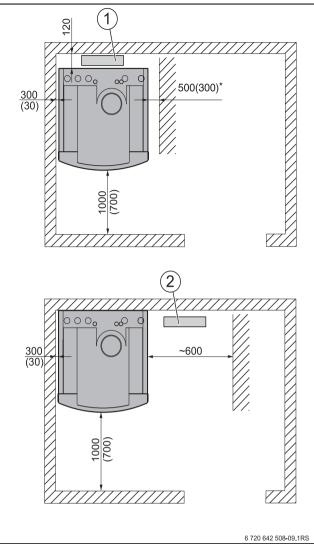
Empfohlene Wandabstandsmaße, in Klammern Mindest-Wandabstandsmaße (in mm)
